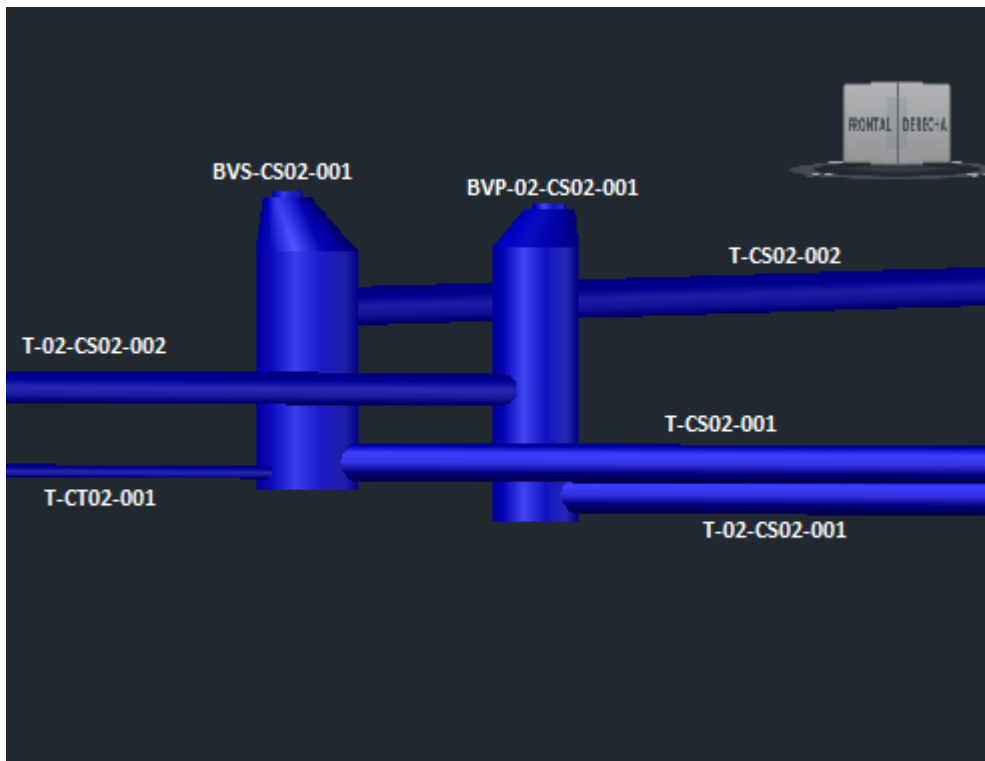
Detalle 2 de redes de drenaje en Civil3D.
